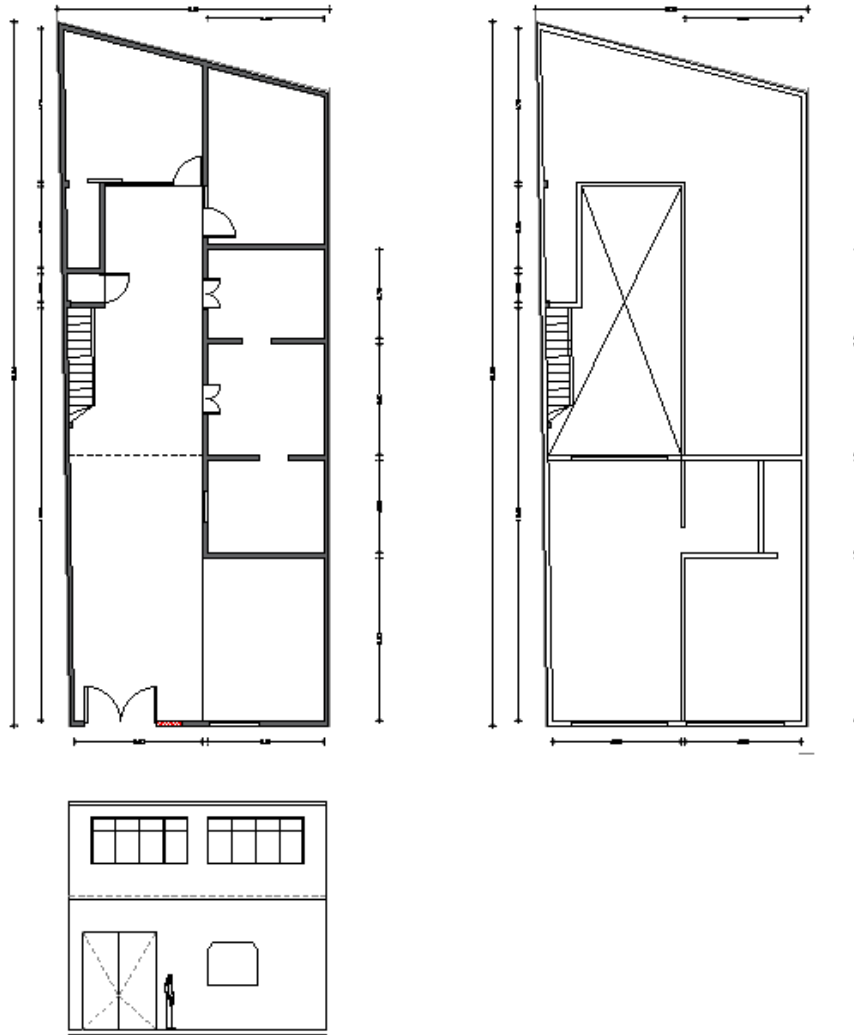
Planos de levantamiento arquitectónico antes de los trabajos de adecuación.
